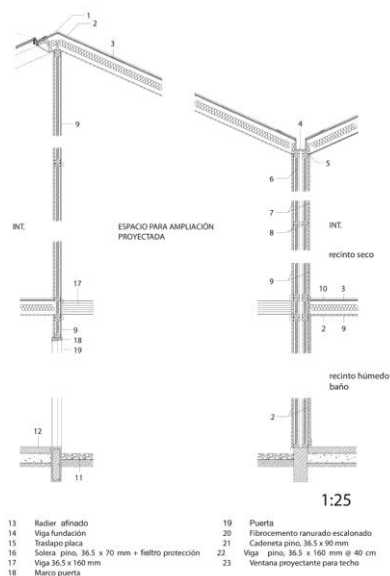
Detalhamento em Corte - Estrutura Construída.
